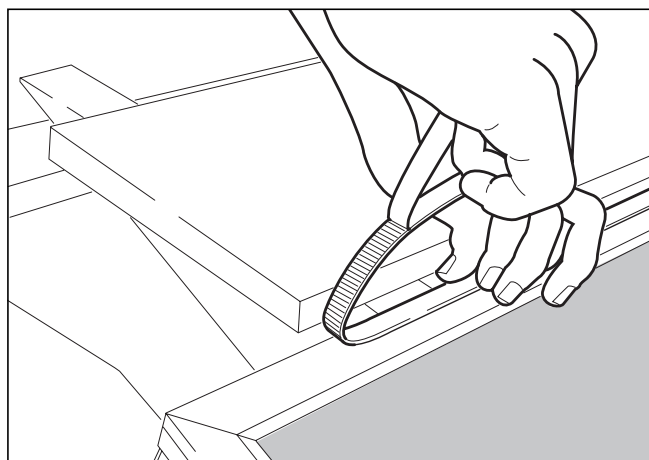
Fixer 3 languettes en tôle sur la bavette en plomb de chaque capteur, à une hauteur aussi élevée que possible.
